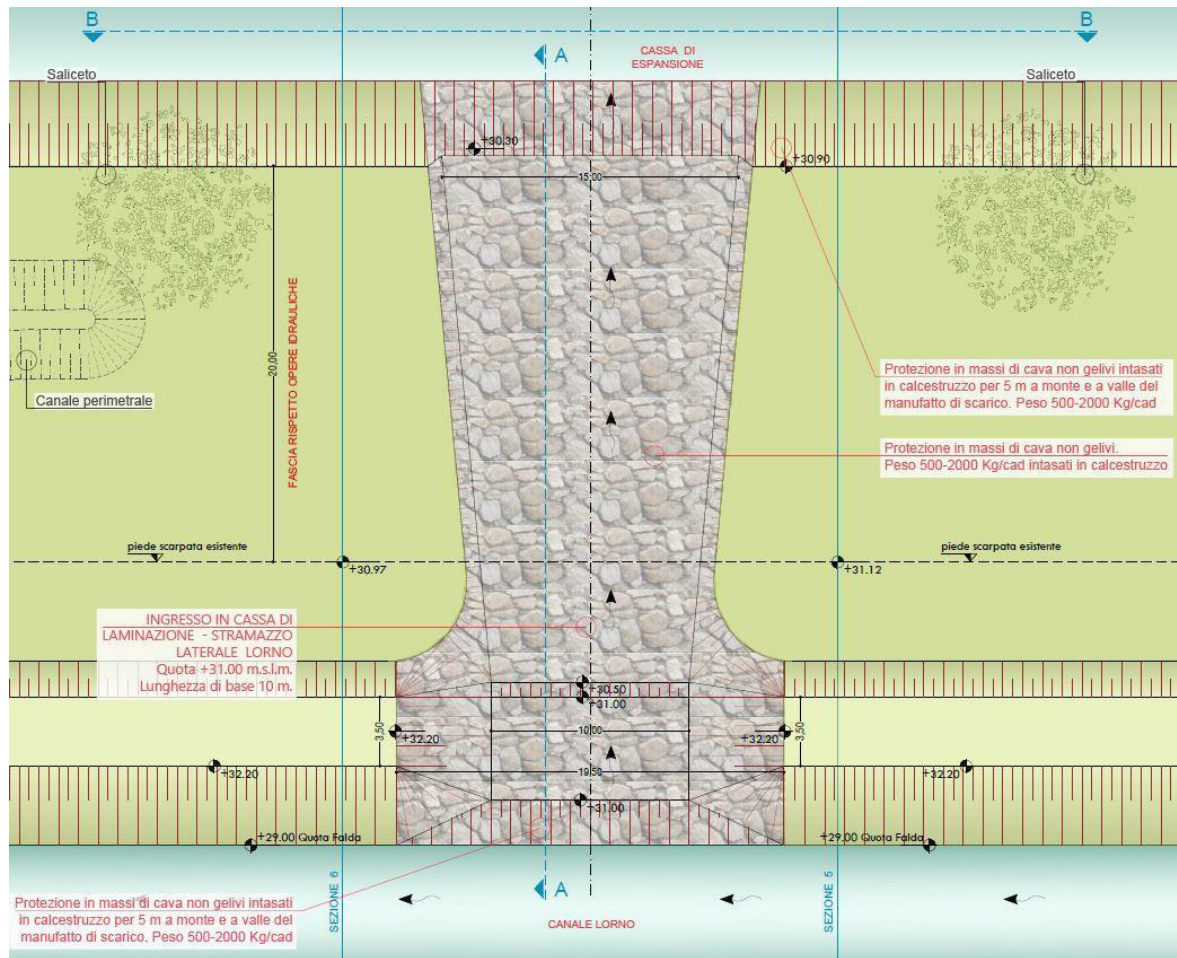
Manufatto di ingresso canale Lorno: planimetria.
